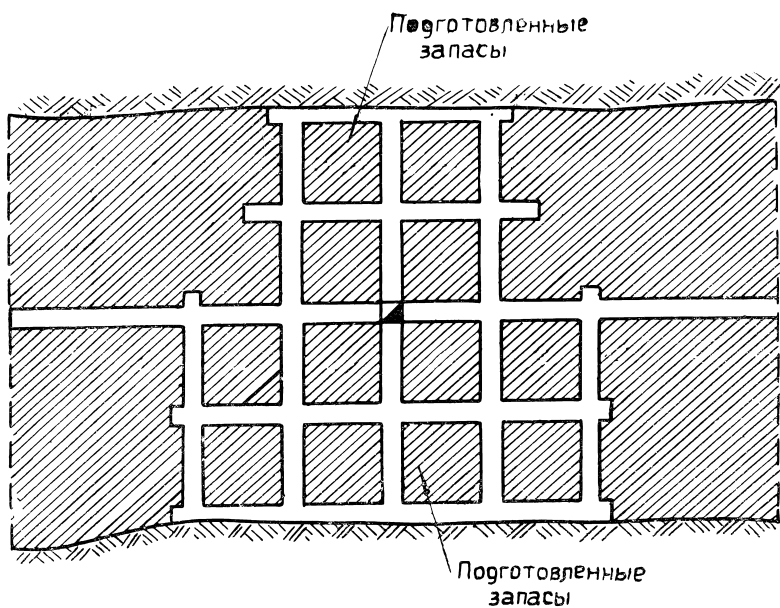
Система разработки короткими столбами без обрушения кровли (с закладкой)
